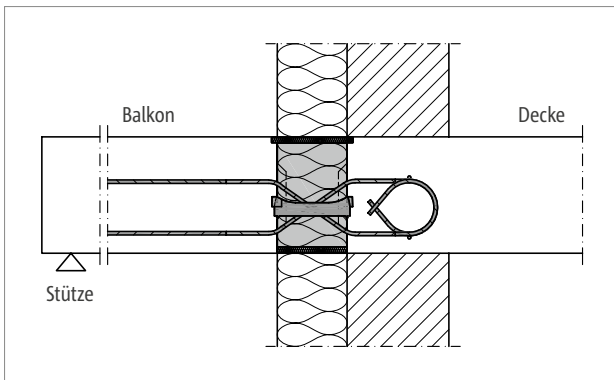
Schöck Isokorb® XT Typ QL-VV: Anschluss bei Wärmedämmverbundsystem (WDVS)
